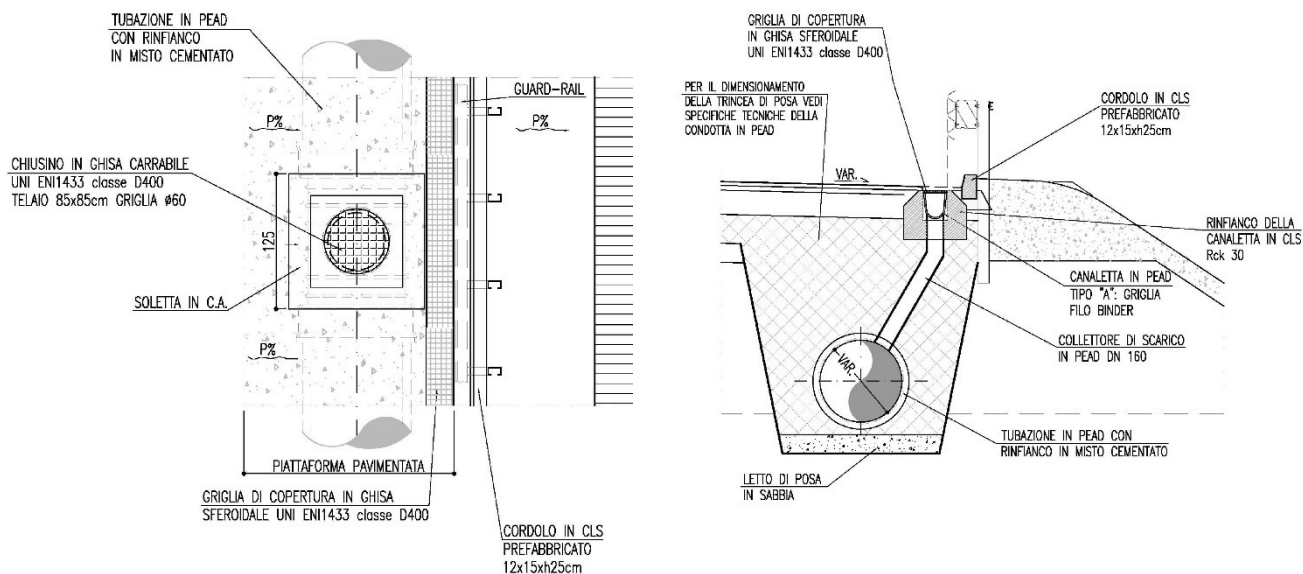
Pianta tipo pozzetto di ispezione e sezione tipo con scarico nella sezione longitudinale nel caso di rilevato
